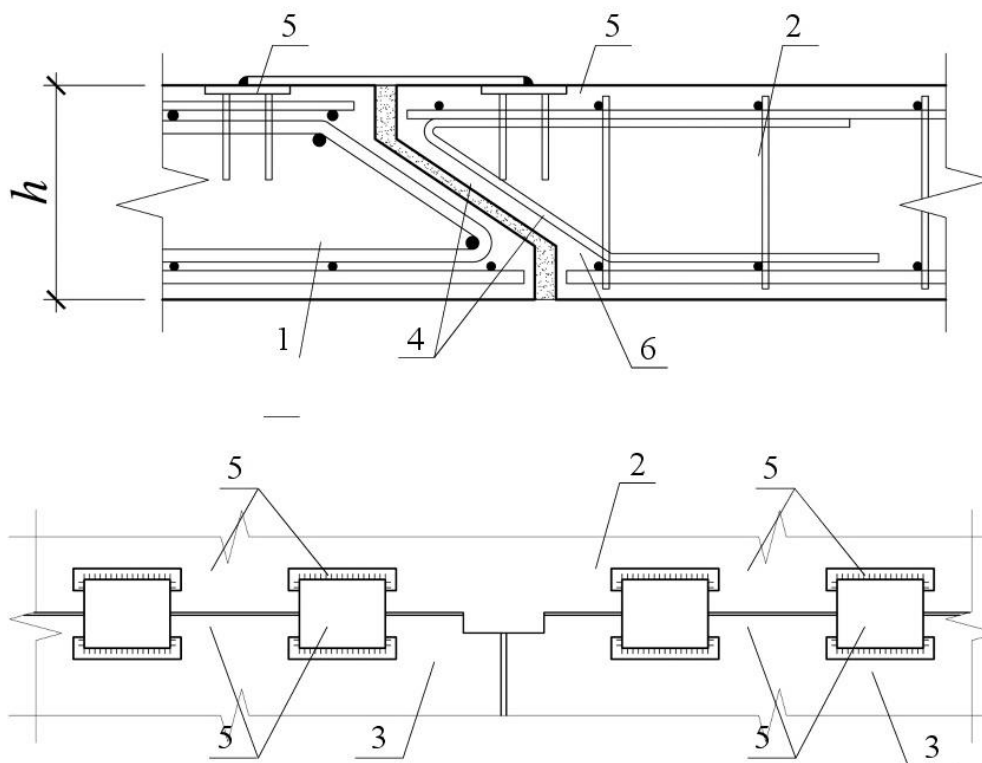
Вузол з'єднання плит у збірному безбалковому перекритті:
